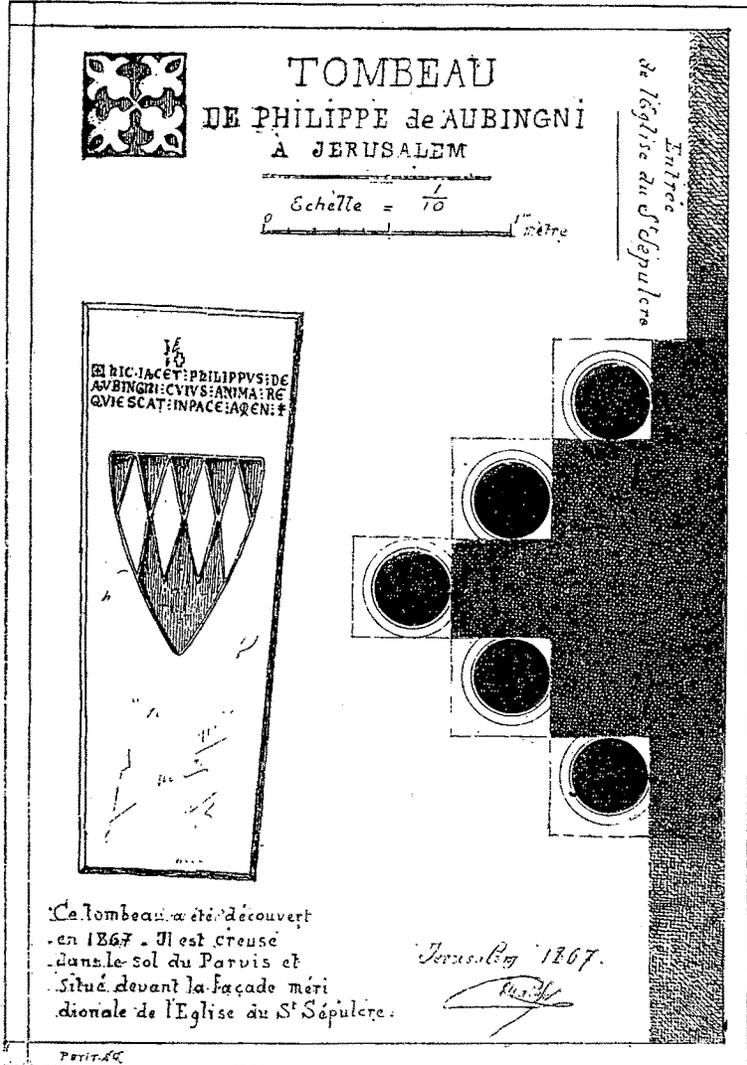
Plan du tombeau de Philippe de Aubingny, situé sur le parvis de l'église du Saint-Sépulcre, au pied de la façade méridionale.
